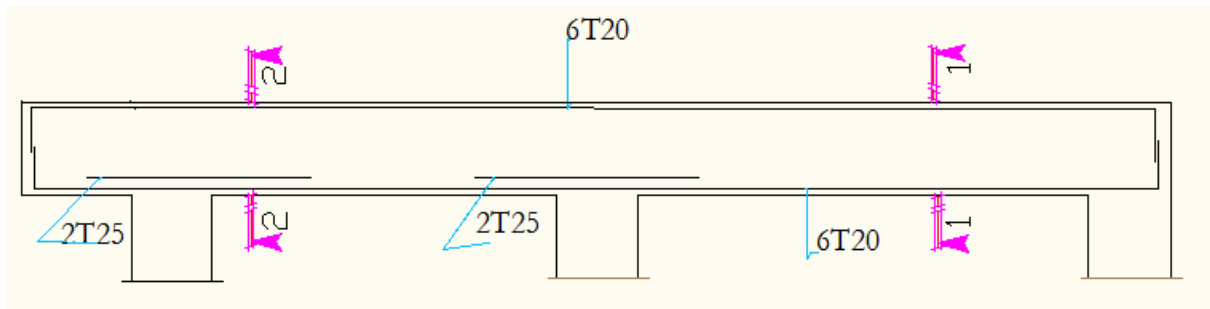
schéma de ferrailage de la poutre de rigidité
